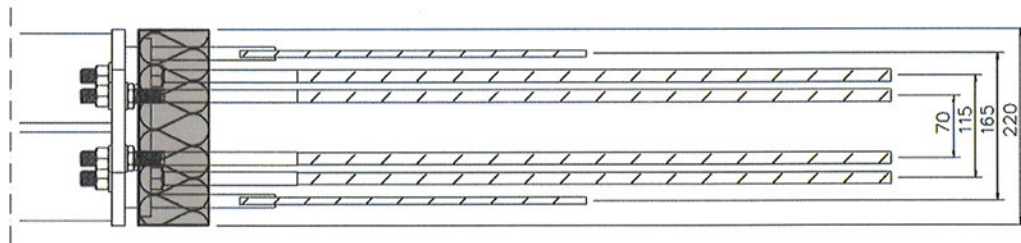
Grundriss Isopro Typ SBM 14 QQ
